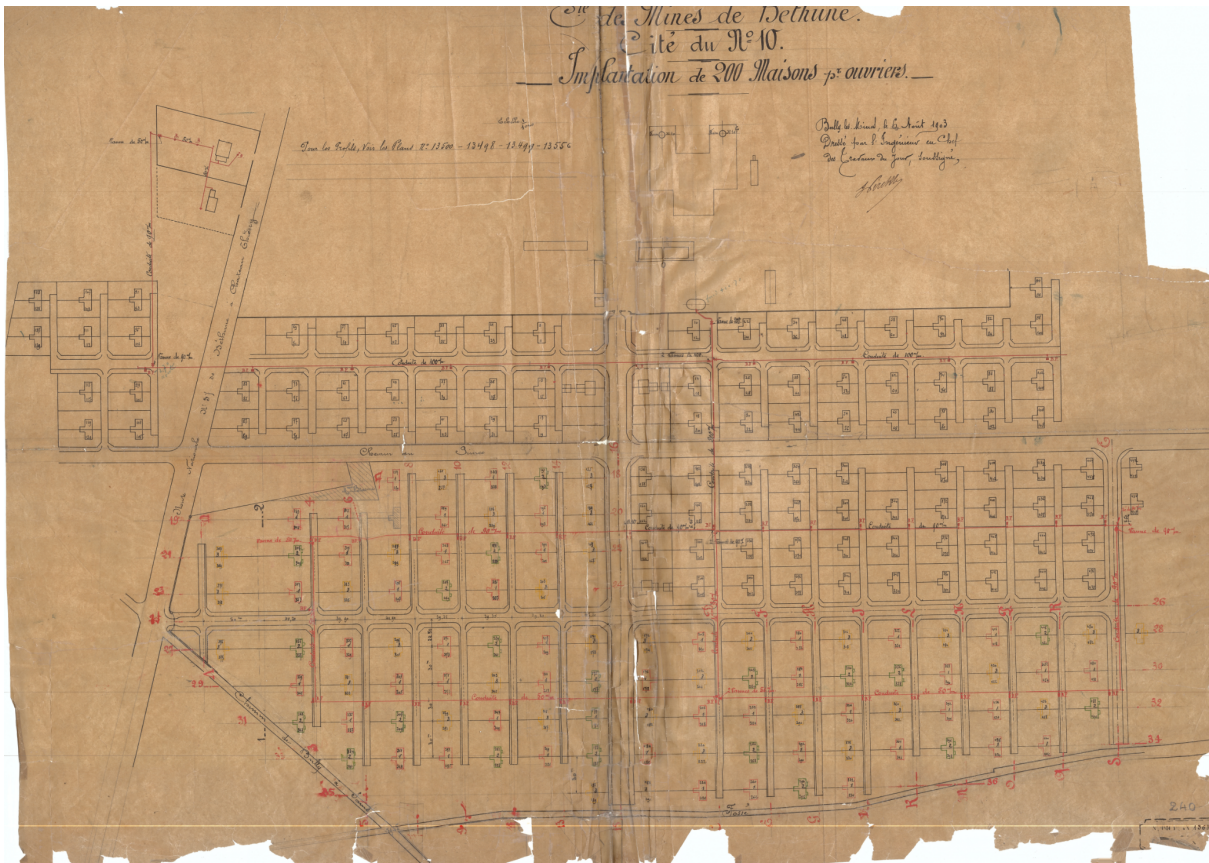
Plan cités pavillonnaires /source Archives Maisons&Cités
